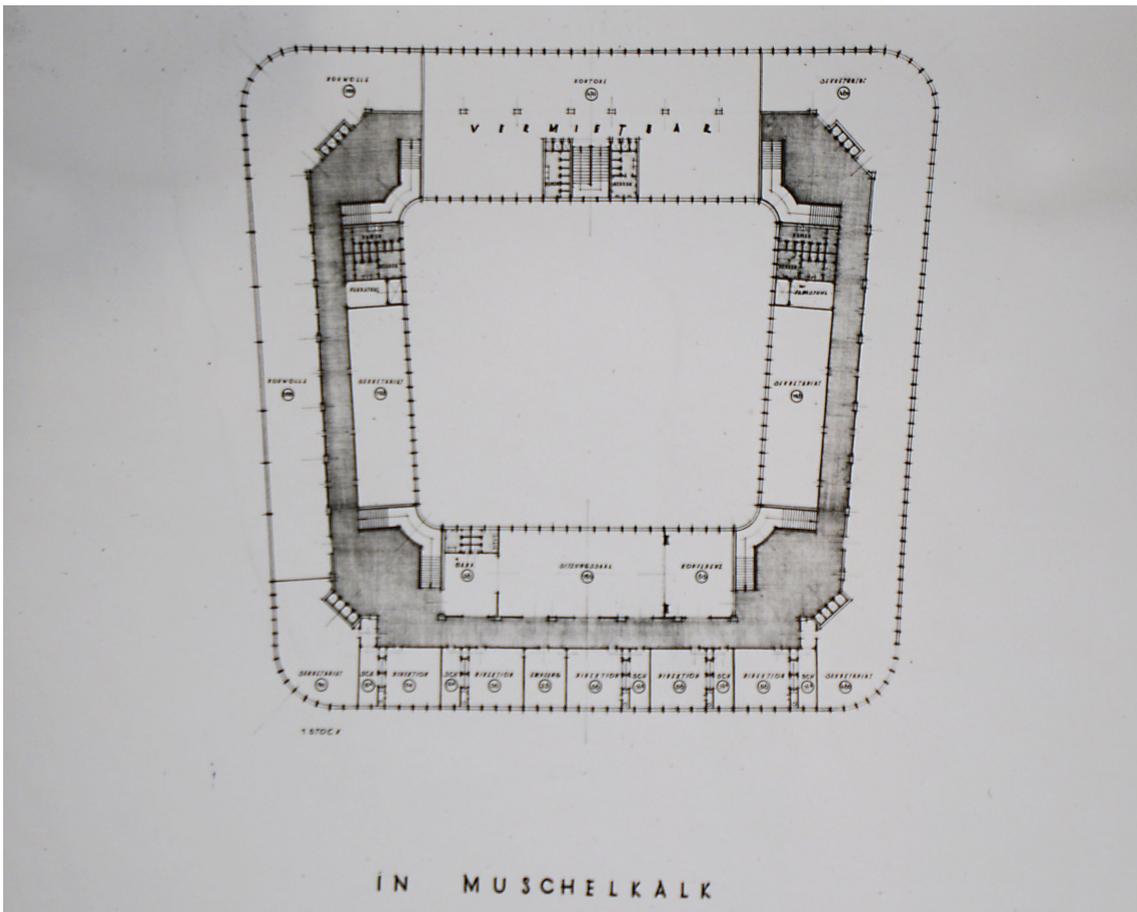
Grundriss Obergeschoss für Wettbewerbseingabe, 1927
